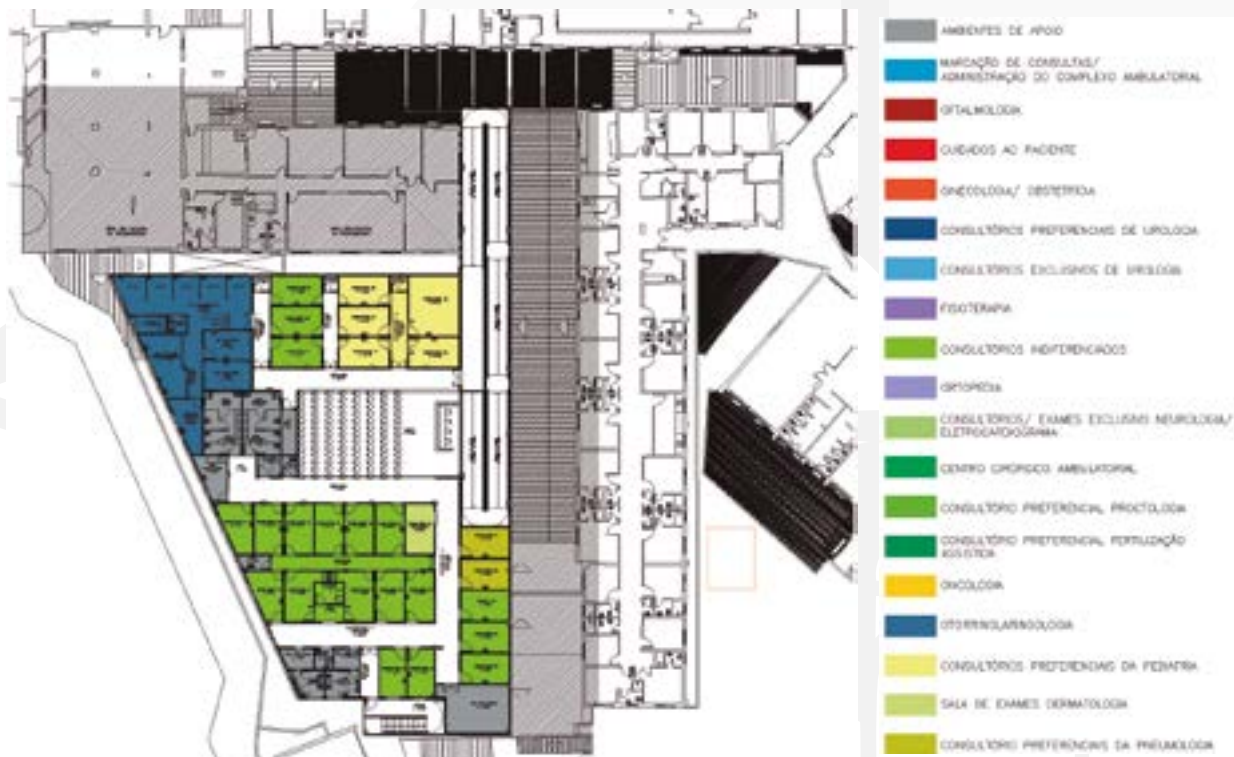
Planta baixa do segundo pavimento do Complexo Ambulatorial do HUAP. Sem escala.
